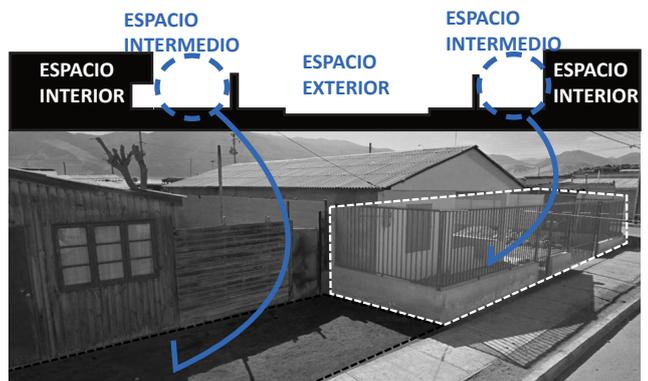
Chañaral, casas espacio intermedio (Elaboración propia)
